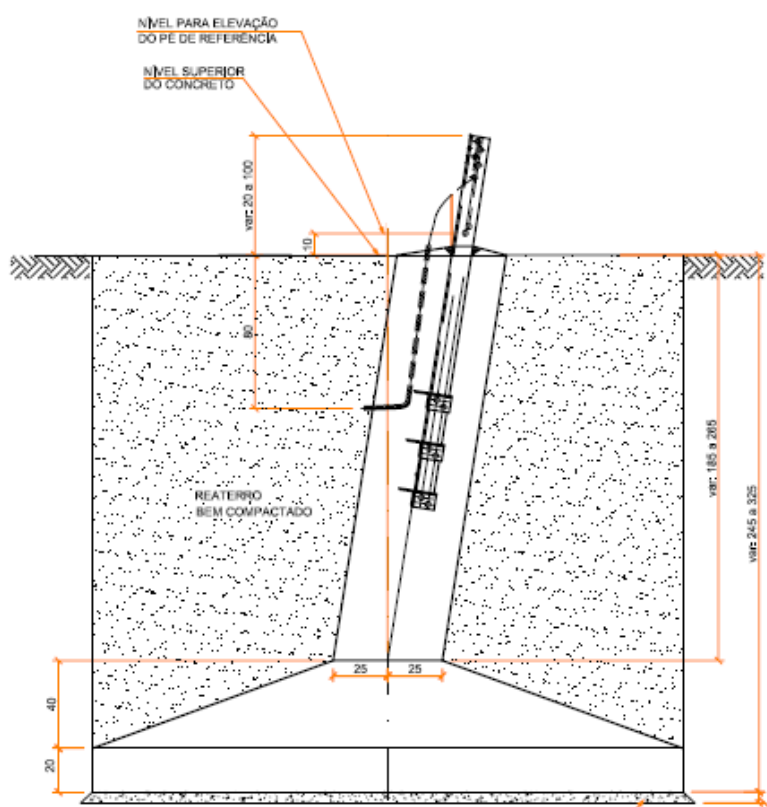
FUNDAÇÃO EM SAPATA
